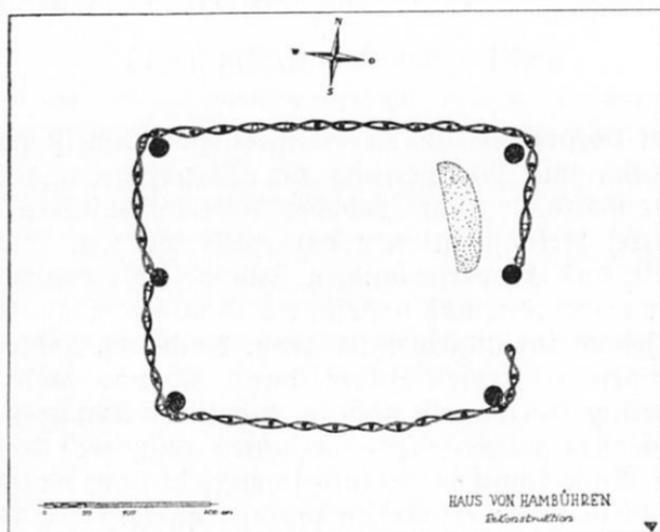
Haus von Hambühren. Rekonstruierter Grundriß.
